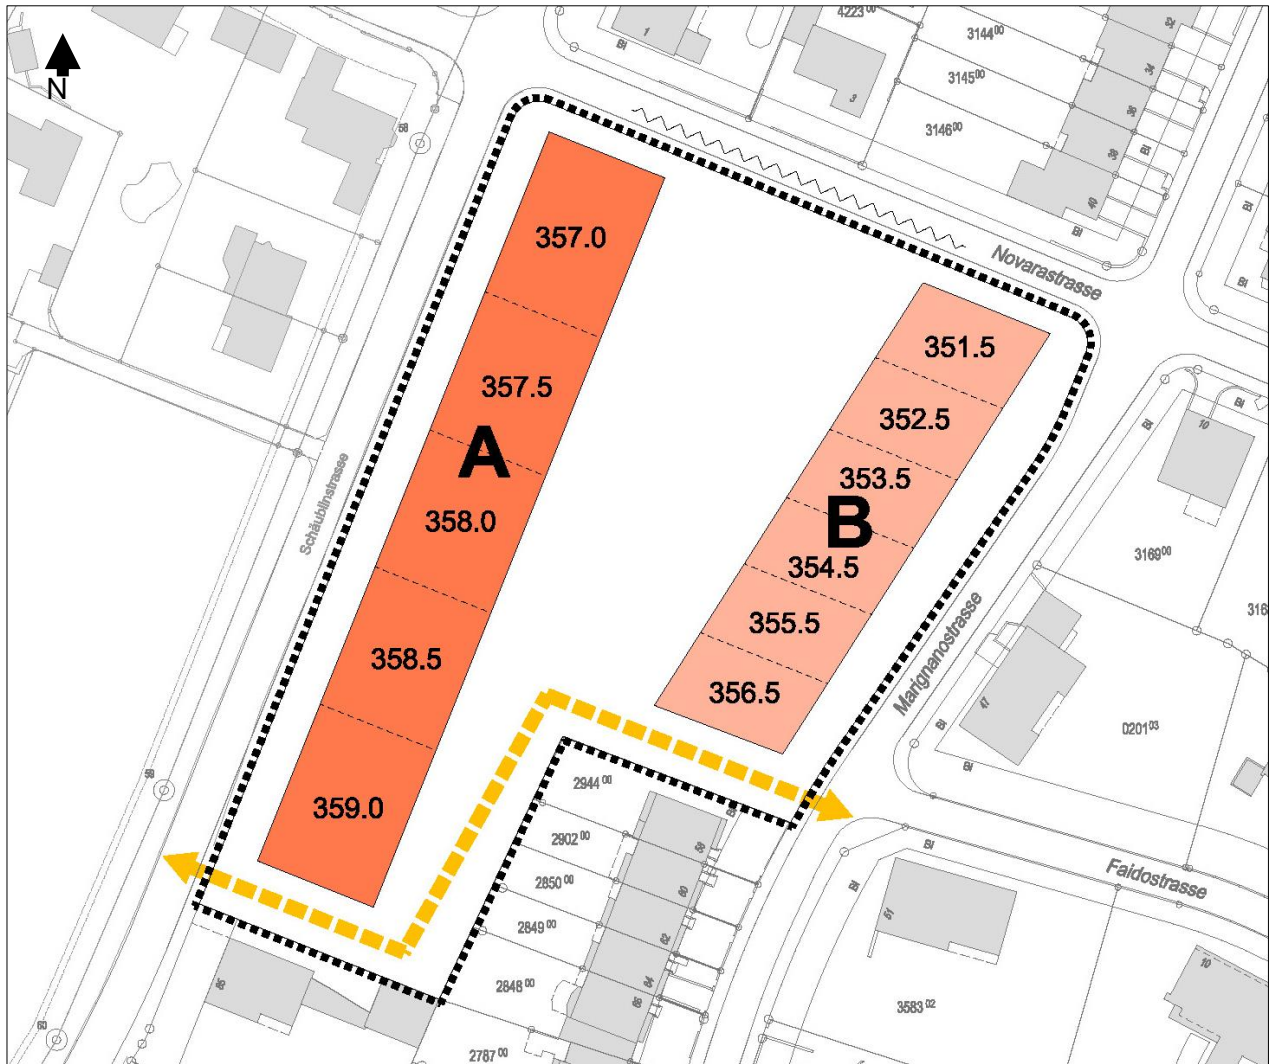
Neuer Bebauungsplan Plan Nr. 14'155 (kein Massstab, Plan genordet)
